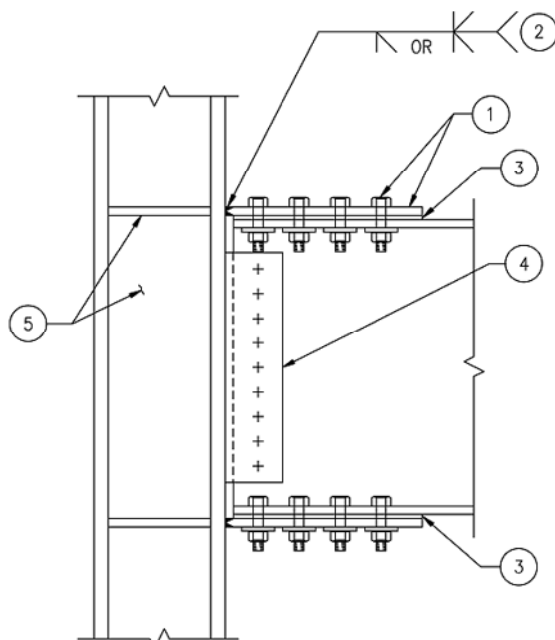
Conexión BFP (Bolted Flange Plate)
